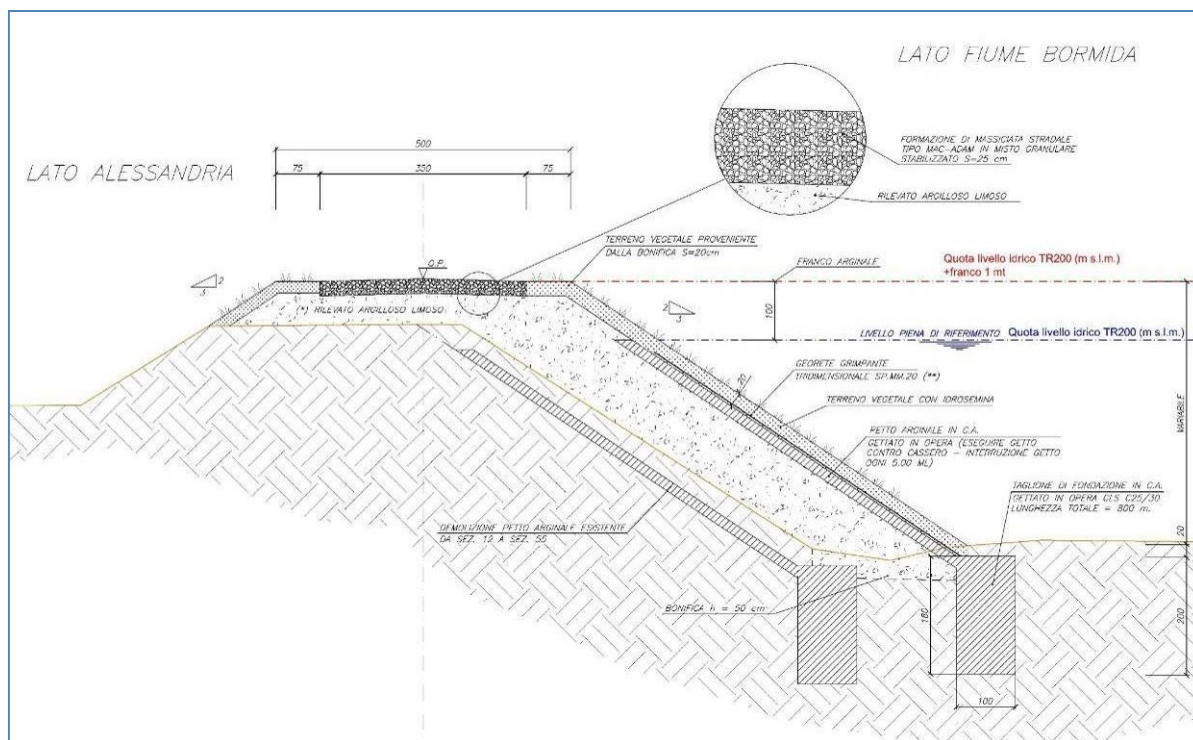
Argine sinistro, opera 5 - sezione trasversale tratto sezione 12 - sezione 56
